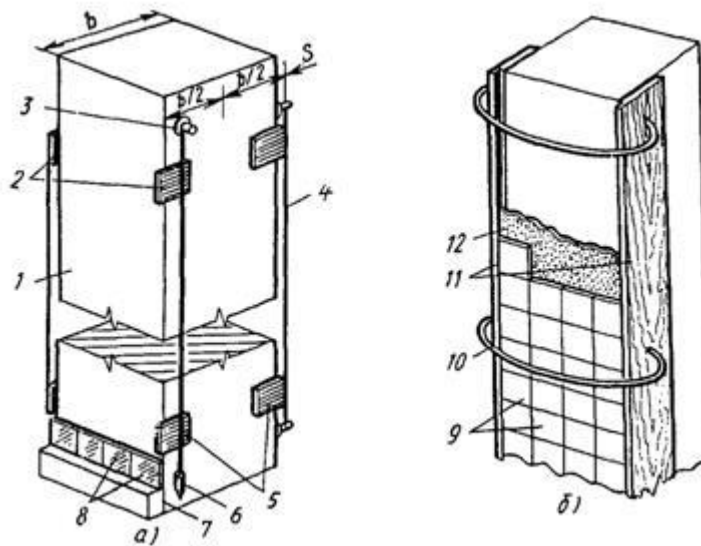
Облицовка прямоугольных колонн и пилястр:
